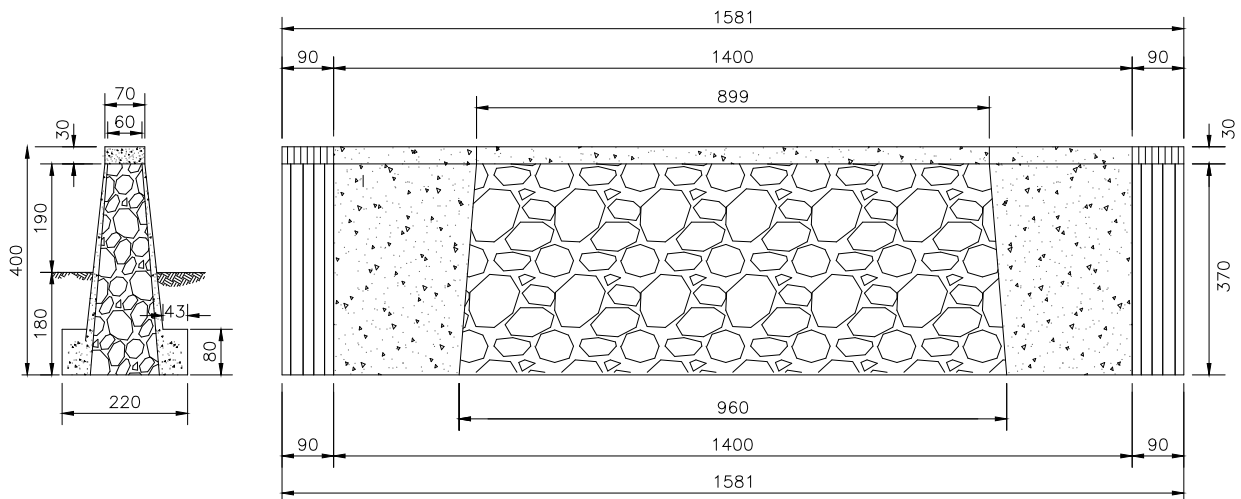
Geometría de las Pilas Conforme a Proyecto
